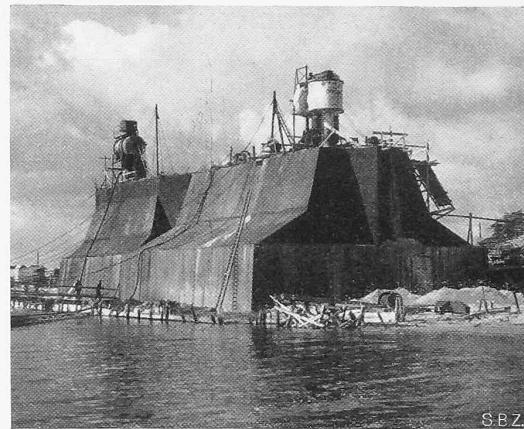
Caisson für Pfeiler 7. Grundfläche 22×18 m.
